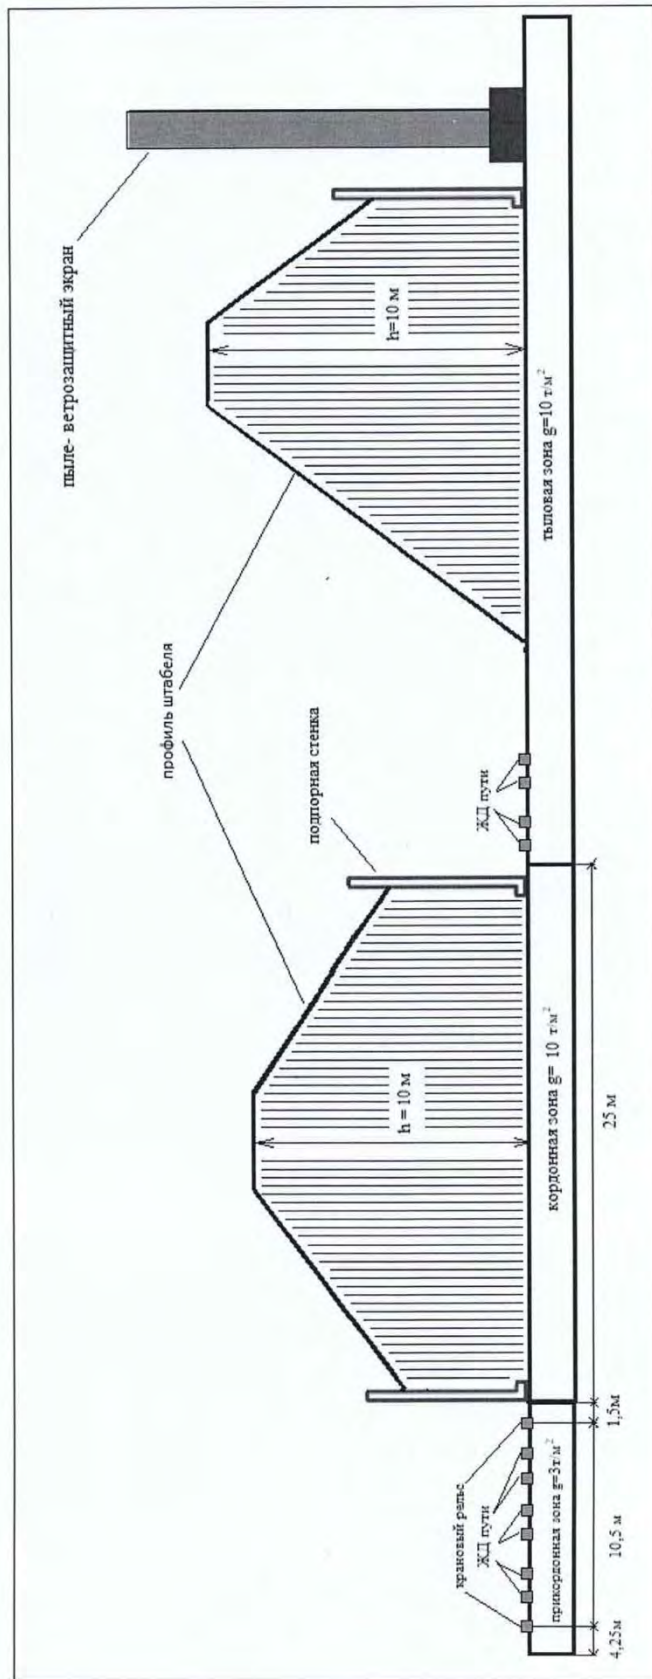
Схема нагрузок на покрытие и высота штабелирования.
